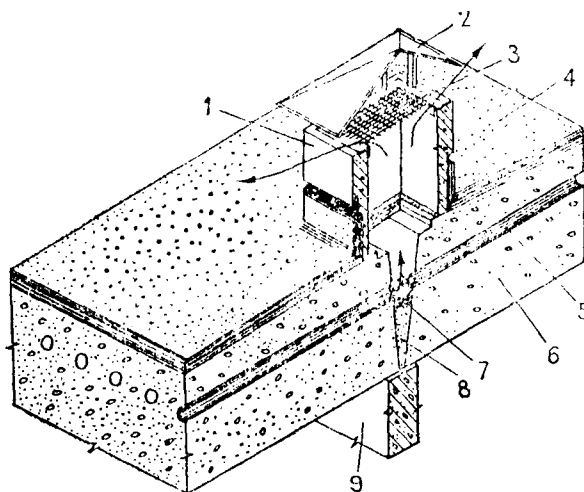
Конструкция вентилируемого бесчердачного покрытия с наружным водоотводом
